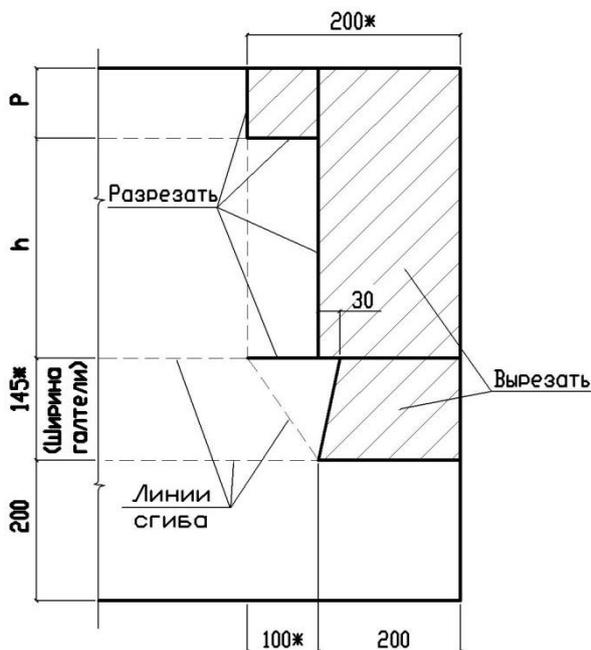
Выкройки для армирующего материала при устройстве гидроизоляции внешнего угла парапета.
